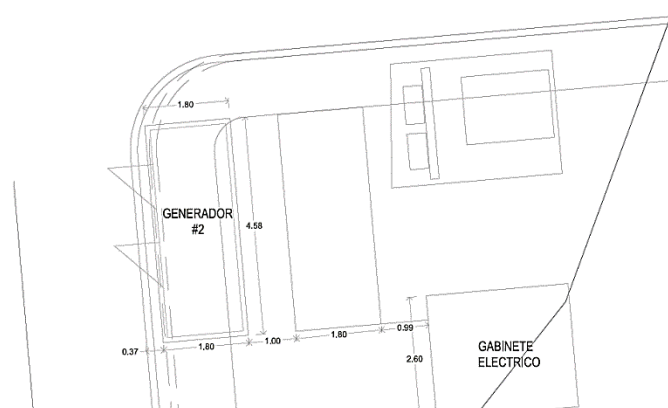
Plano de generador y gabinete eléctrico, Torre GK
